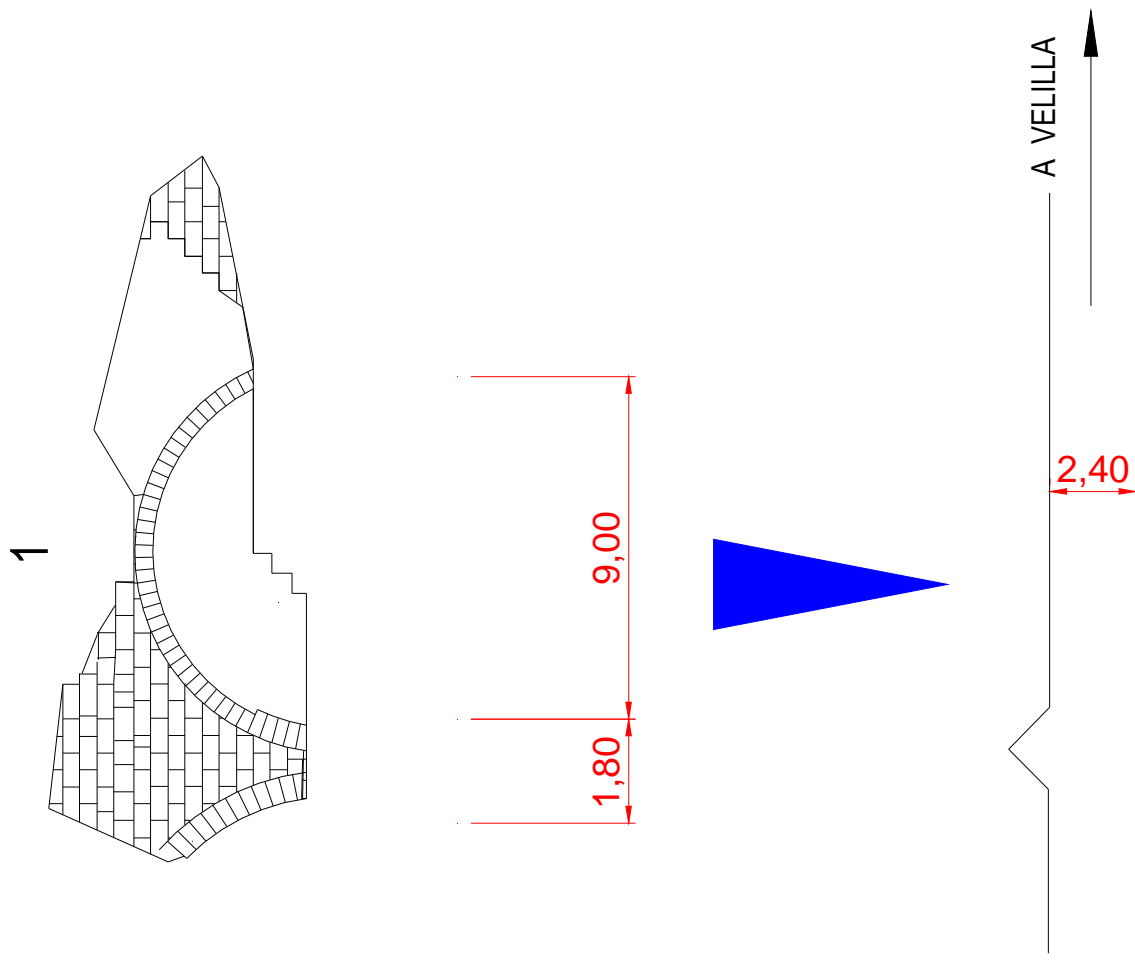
Planta y alzado de aguas abajo del puente medieval en Velilla del río Carrión
